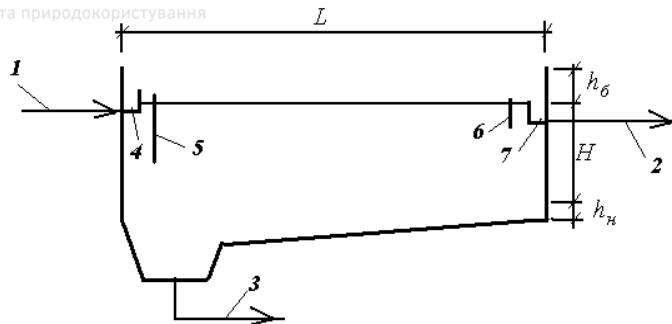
Розрахункова схема горизонтального відстійника
